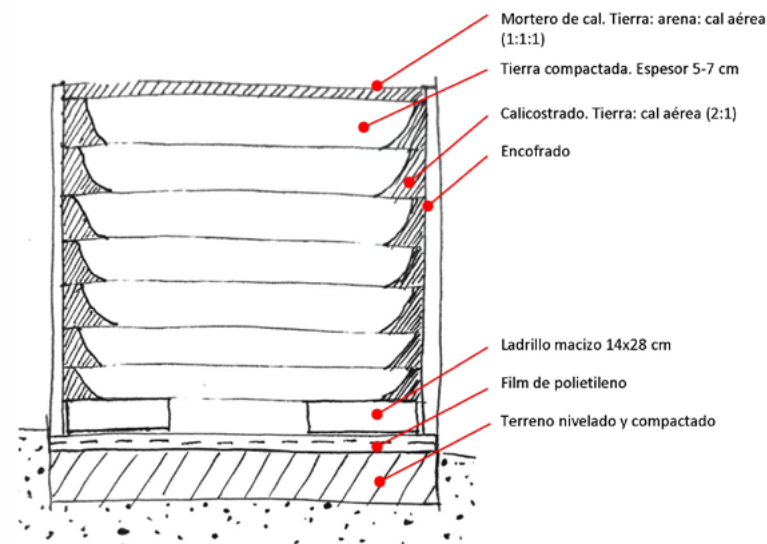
Sección transversal del diseño constructivo para la pieza de tapia
